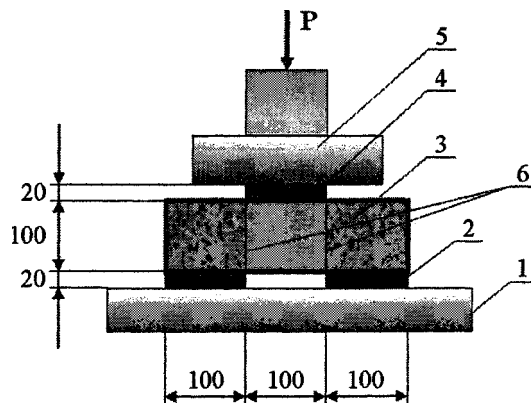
Схема проведения испытаний бетонной балочки на срез в зоне технологического шва: 1 - опорная площадка пресса П-10; 2 - металлические пластины размером 100x100x20 мм, закрепленные к опорной площадке; 3 - испытываемый образец-балочка; 4 - металлическая пластина размером 100x100x20 мм передающая нагрузку на среднюю часть образца; 5 - рабочий шток пресса создающий сжимающее усилие; 6 - плоскости среза
